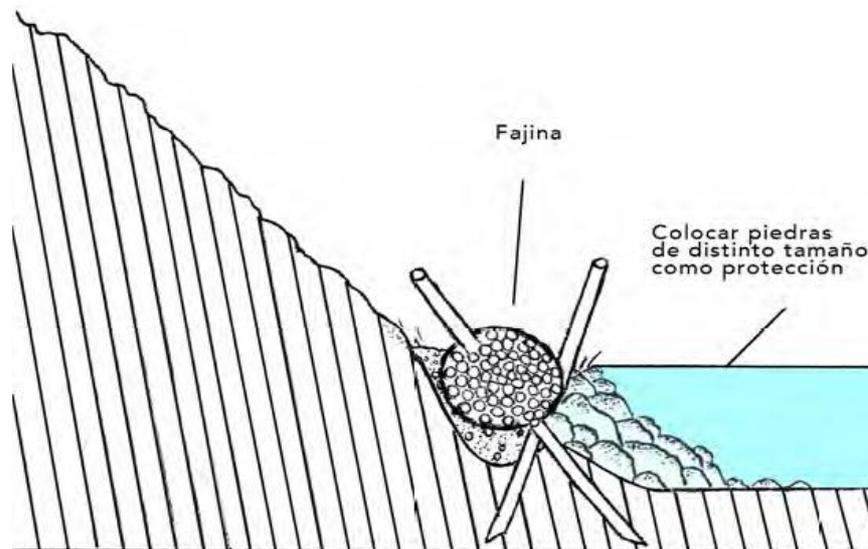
FIJACIÓN DE LA FAJINA CON ESTACAS EN LA RASANTE DEL ARROYO AL PIE DEL TALUD CON ESCARPE DE 45°
